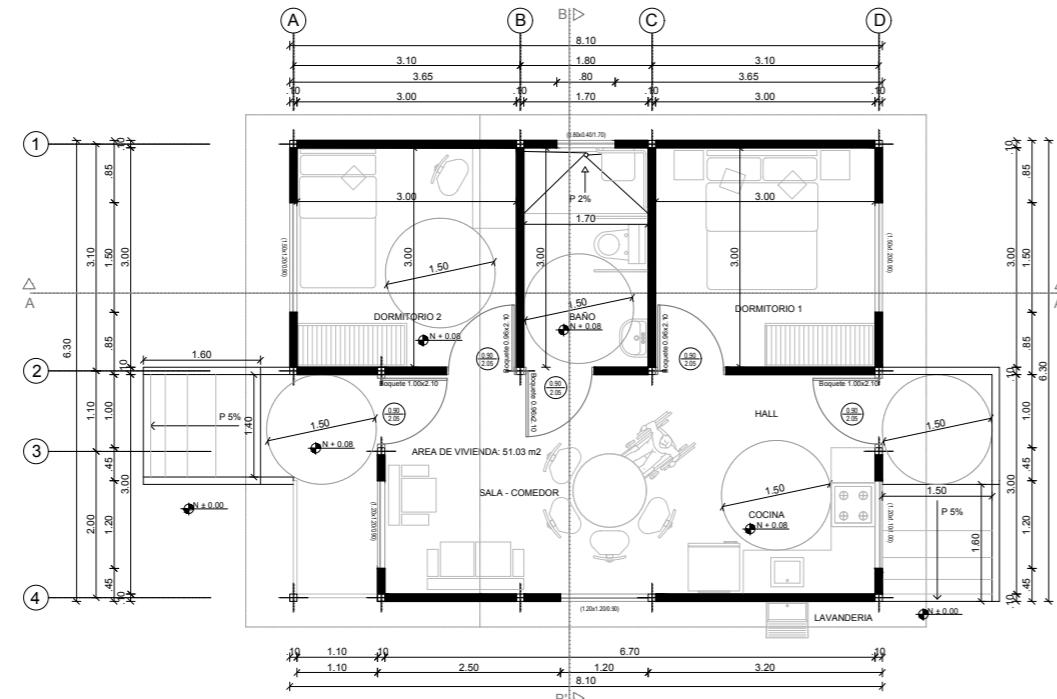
Planta tipo de vivienda tipología 1D, Ecuador Estratégico Empresa Pública. Escala 1:100
